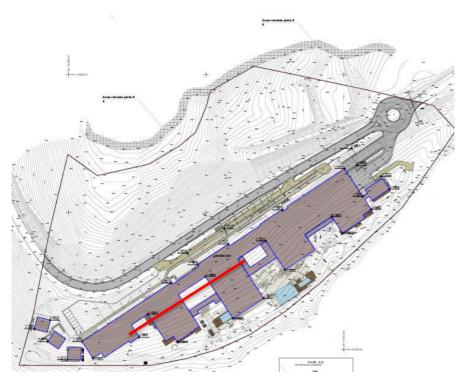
Planta de implantação. Alçado da linha a vermelho presente na Figura 2.
